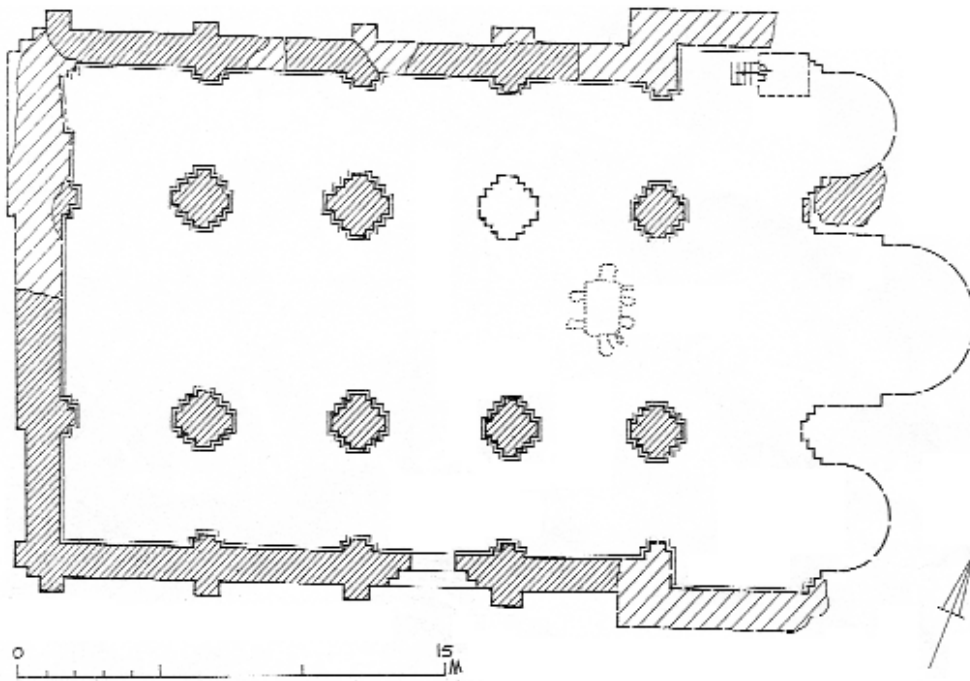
Kreuzfahrerkirche (Kathedrale ?) am Jordan River Hotel, Grundriss (nach Pringle, Harif und Chen)
